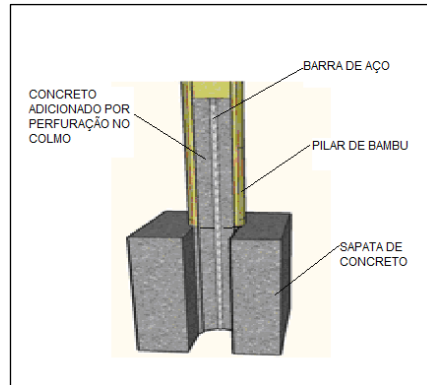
Sistema de apoio com incorporação do pilar a sapata de concreto
